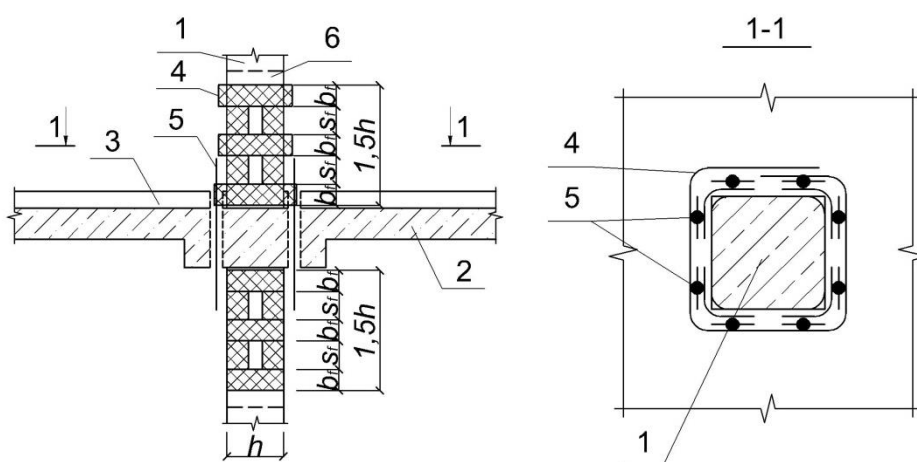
Усиление колонн и пилонов на участке, примыкающем к перекрытию типов 1 и 2
